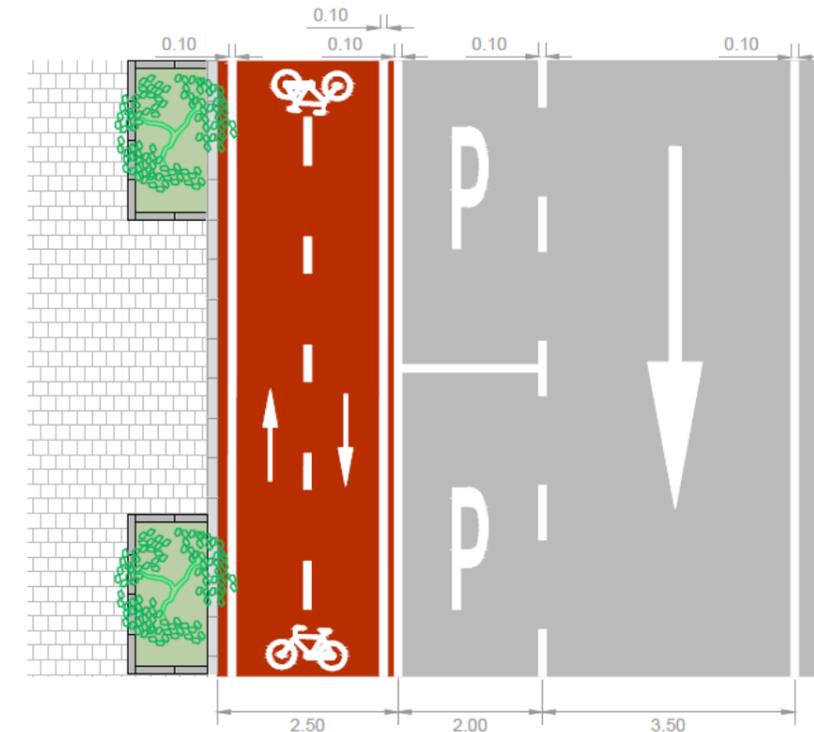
Detalle de carril bici entre acera y aparcamiento.
